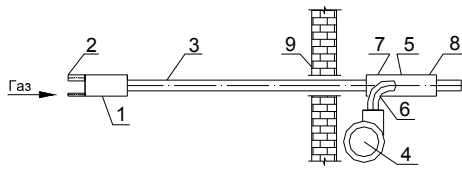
Трубчастий нагрівач з ежектором та забором повітря для припливного вентилятора зовні /Tube heater with ejector and air outlet for exhaust fan:
